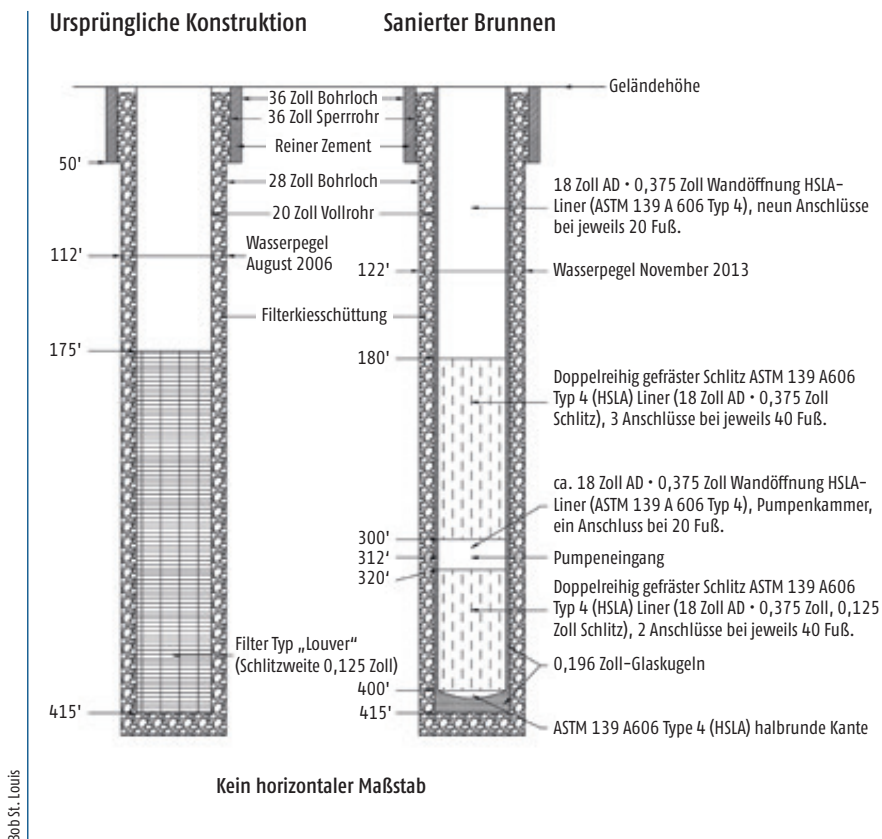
Brunnenausbauplan – links die Originalkonstruktion, rechts der sanierte Brunnen
